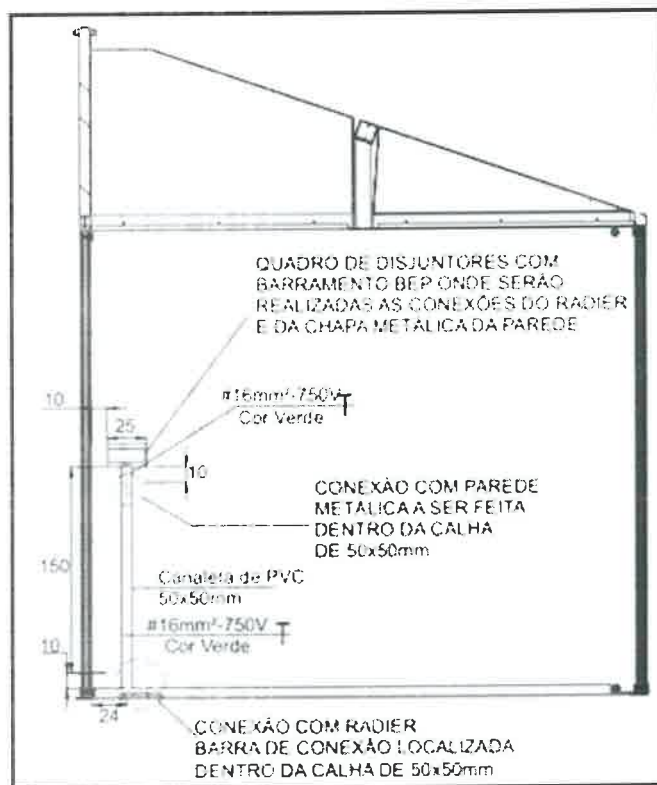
Conexão Barramento BEP x Radier x Chapa Metálica do Painel
